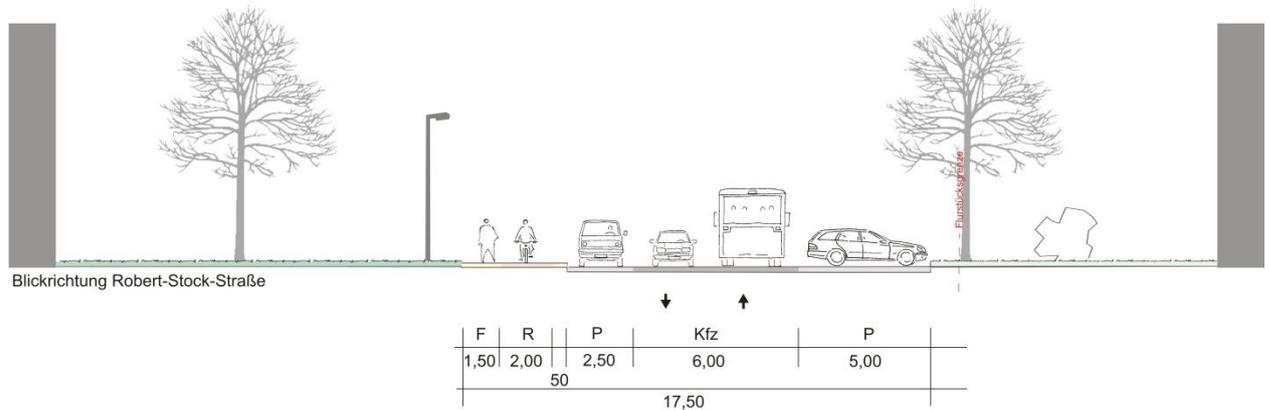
Querschnittaufteilung der Möllner Straße - Bestand
